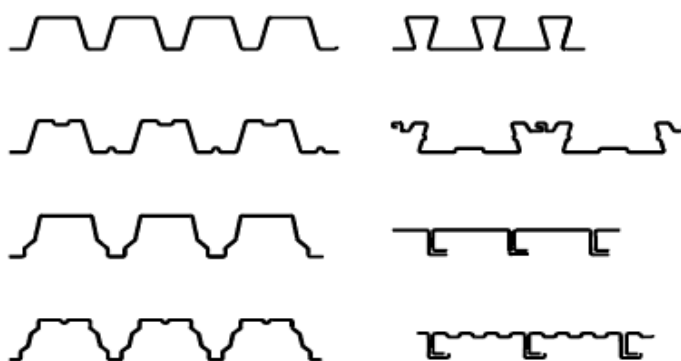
Painéis de chapa e chapa perfiladas enformadas a frio de aço [42]
